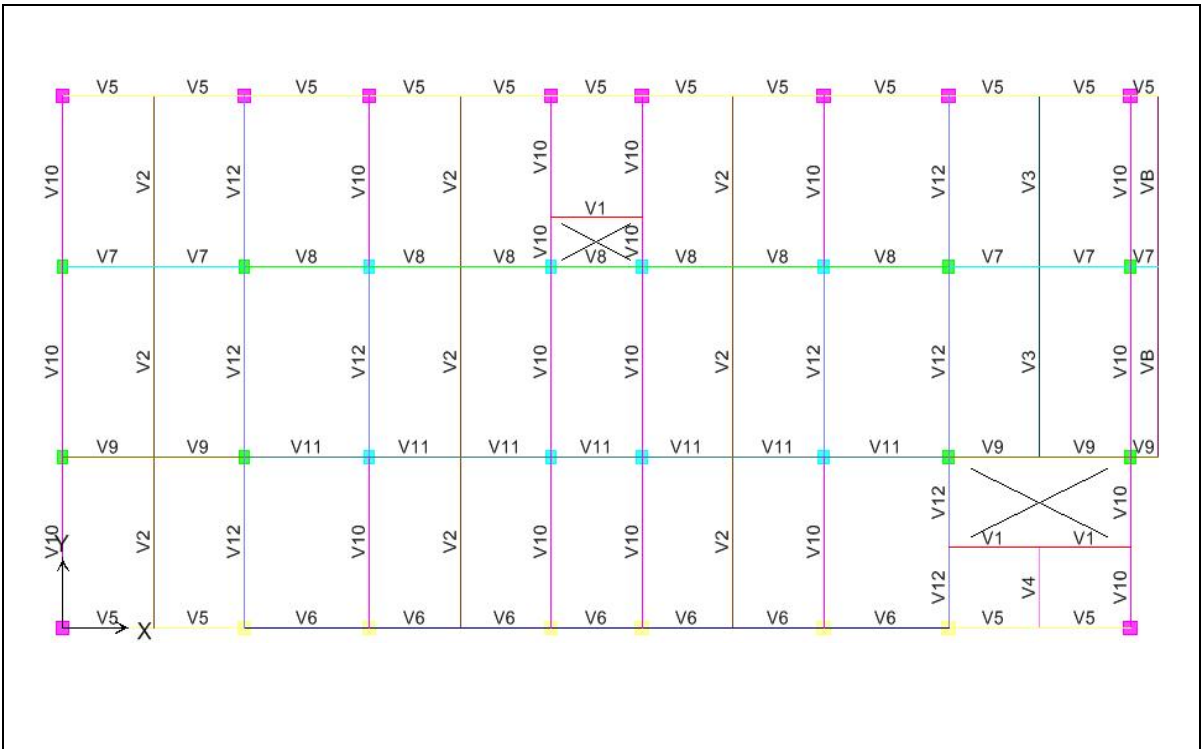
Elementos Tipo Viga – Planta Tipo 1
